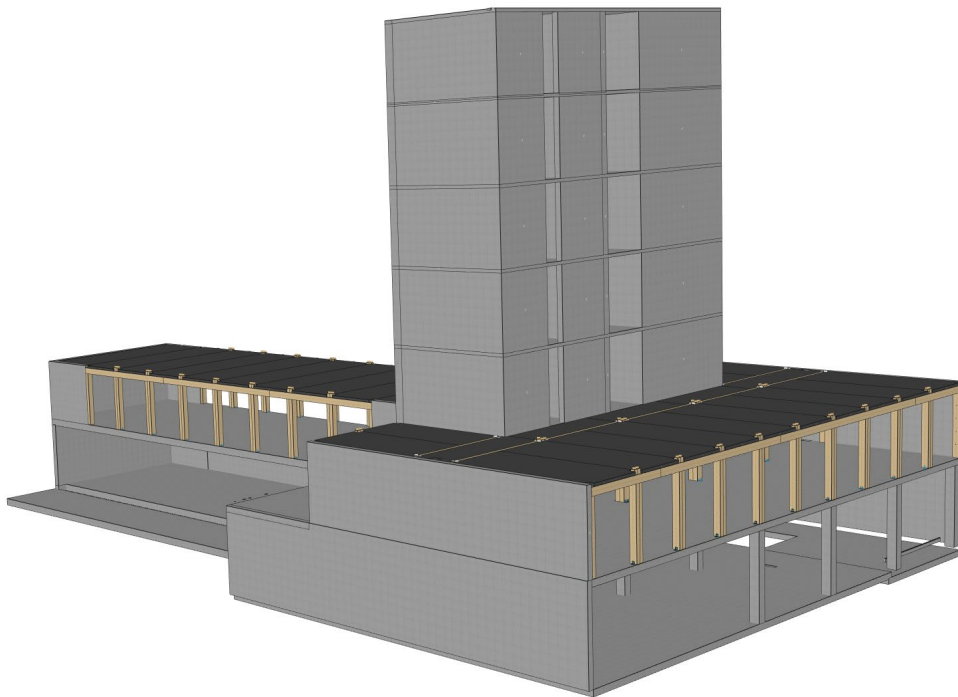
Planung Montage tragender Holzbau mit HBV-Decken (Sieveke)
